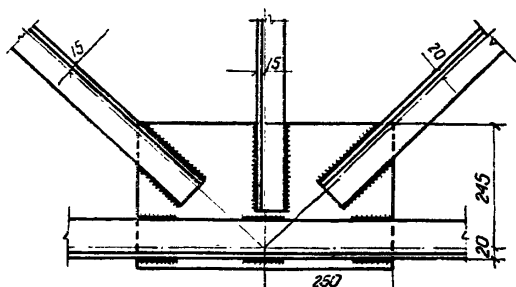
Промежуточный узел нижнего пояса сварной стропильной фермы
